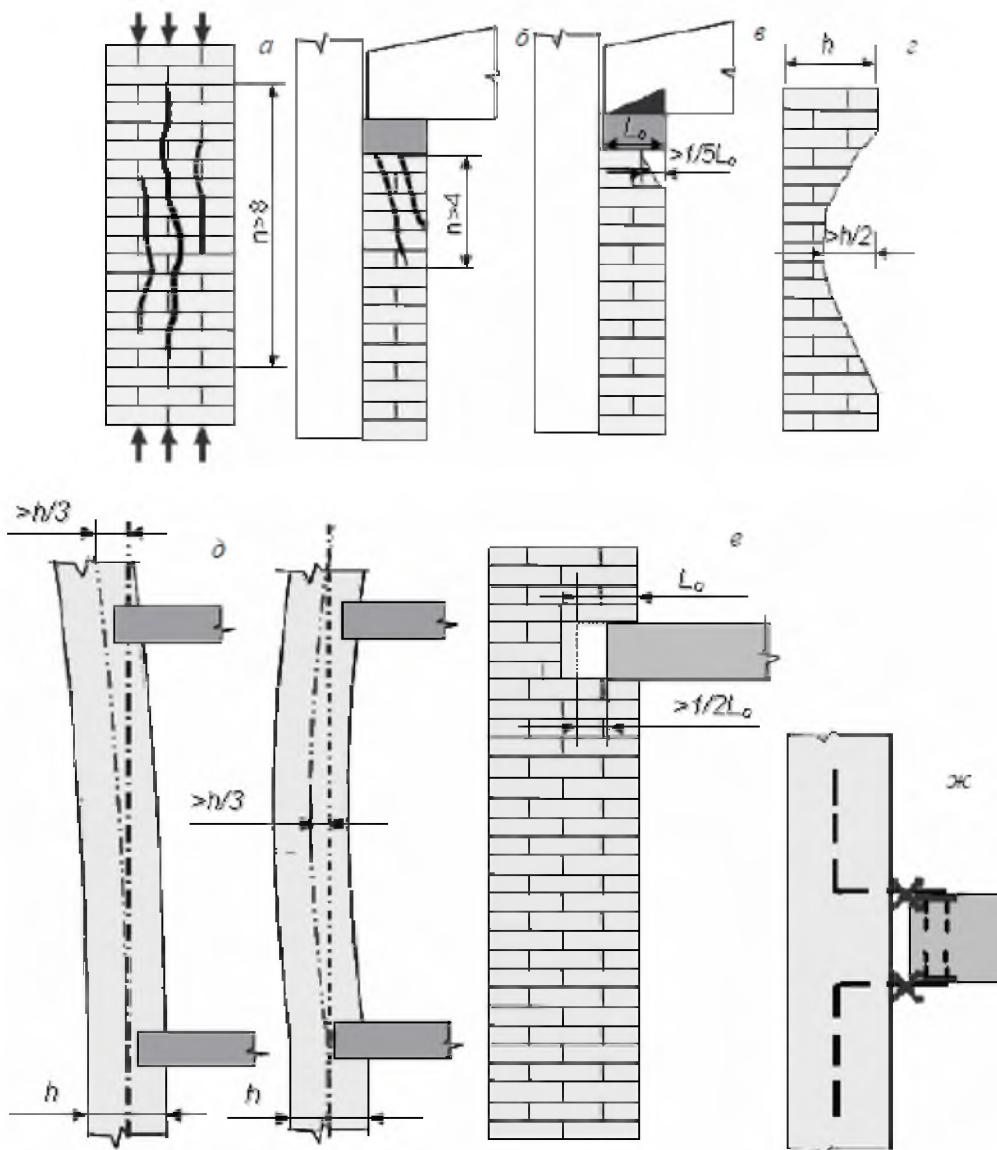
Ознаки передаварійного стану кам'яних конструкцій
